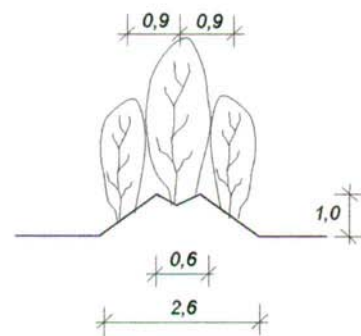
Aufbau einer Wallhecke (Querschnitt)
